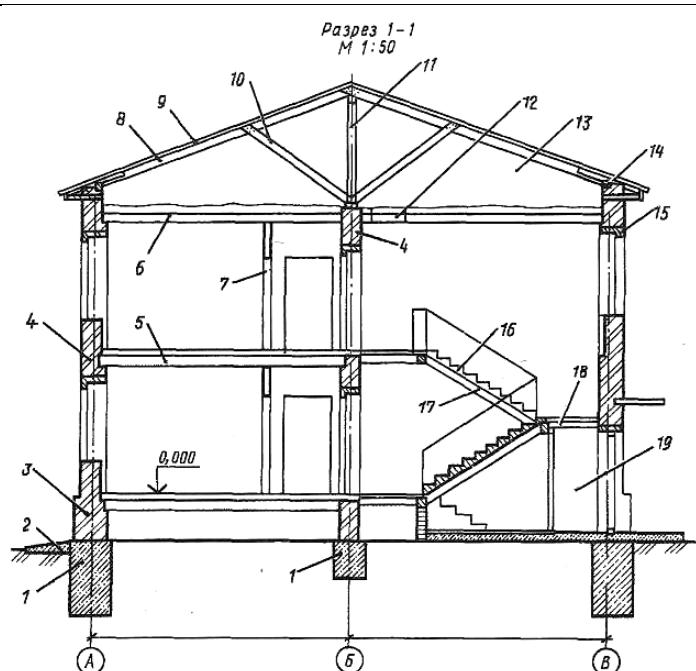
Конструктивные элементы здания с несущими стенами:
